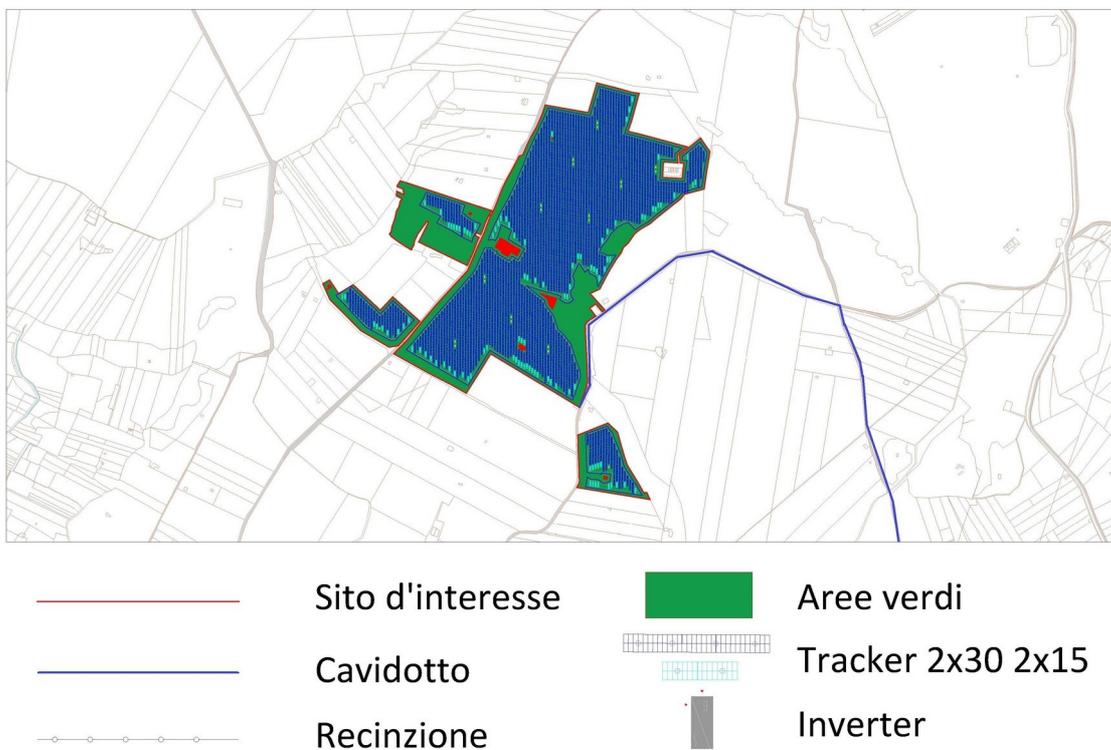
Layout dell'area d'impianto ricadente sul territorio di Menfi (AG) località Genovese con cavidotto
